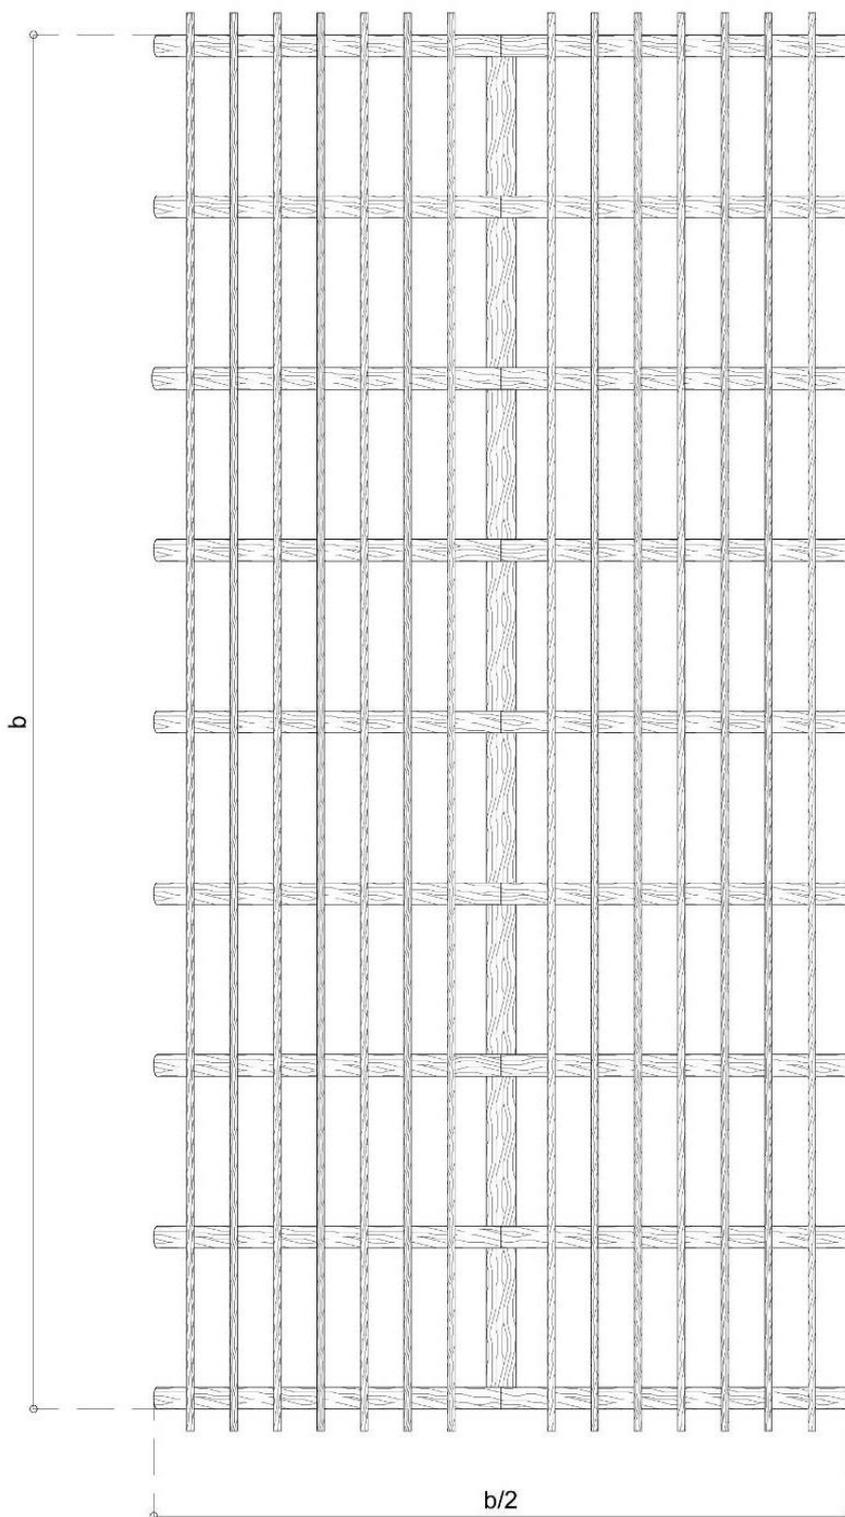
Casone secondario. Pianta dell'orditura strutturale.
